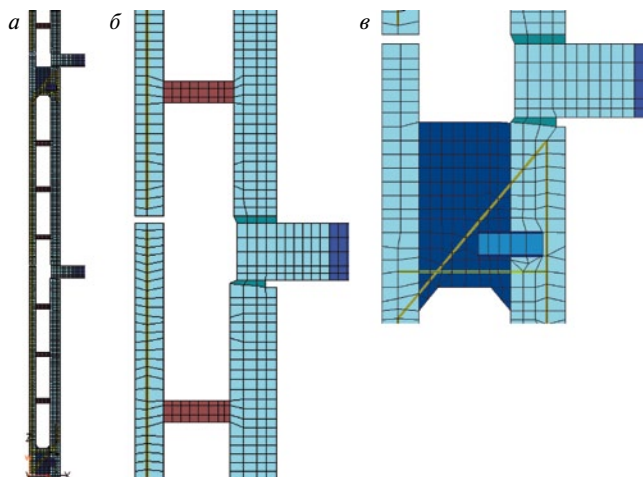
КЭ-модель с уступами под плитой: а – сечение по наружным панелям цокольного и 1-го этажей; б – стык панелей цокольного и 1-го этажей; в – стык панелей 1-го и 2-го этажей
